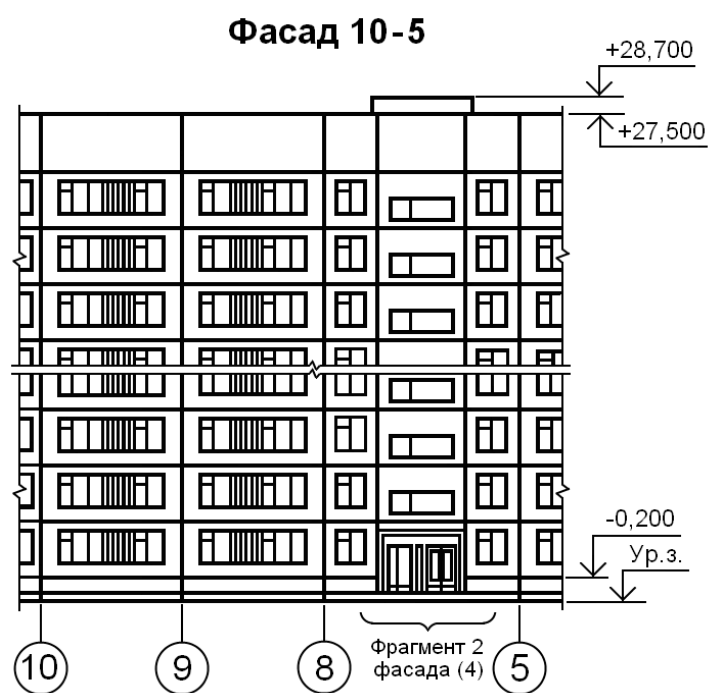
Пример выполнения фасада жилого дома
